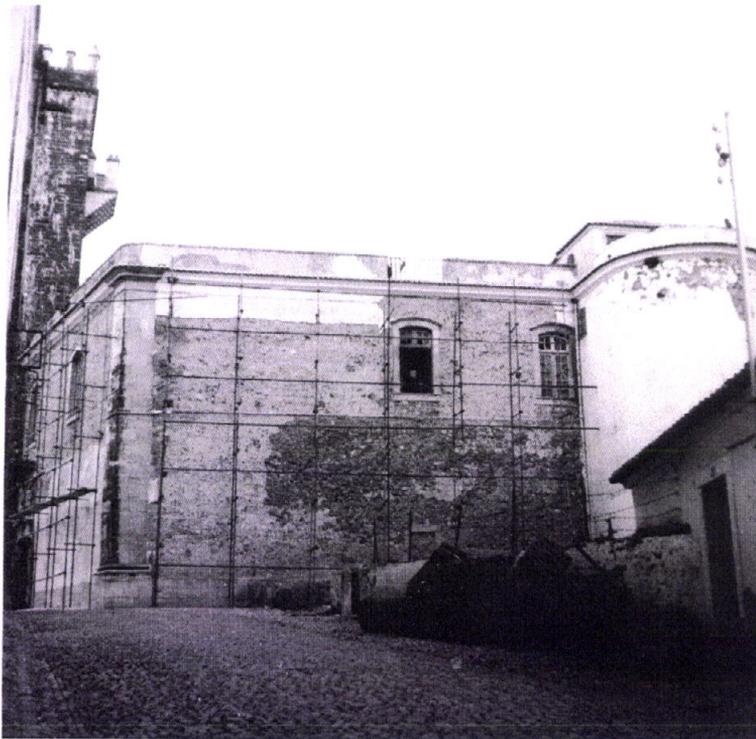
Castelo. Fachada E, durante as obras de adaptação a Pousada (05/01/1968)
